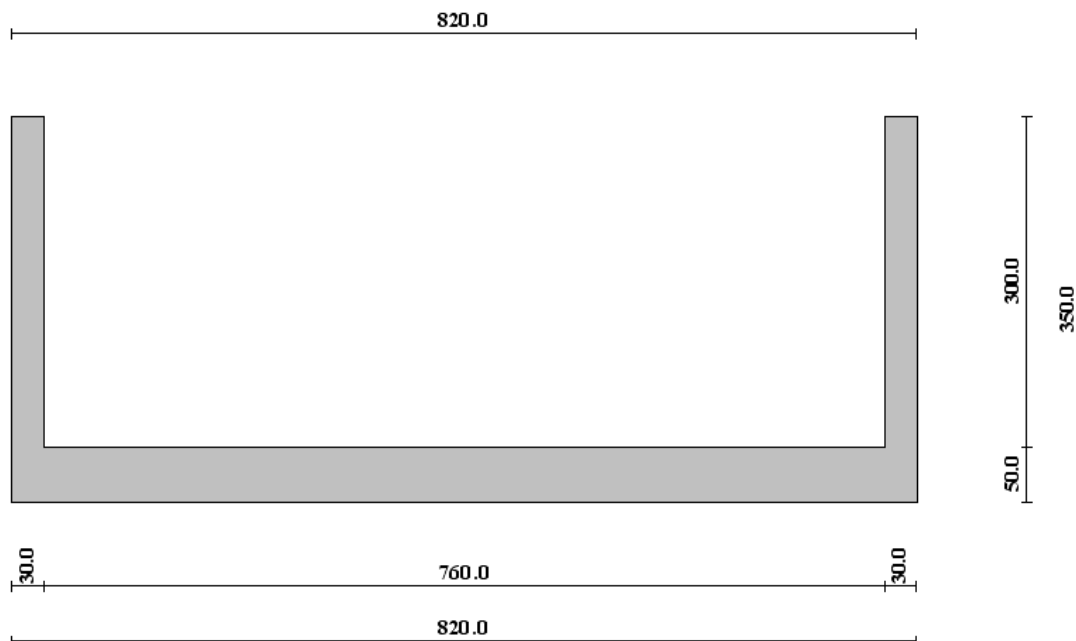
Schema semplificato dell'opera di scarico (sezione tipo 1)
